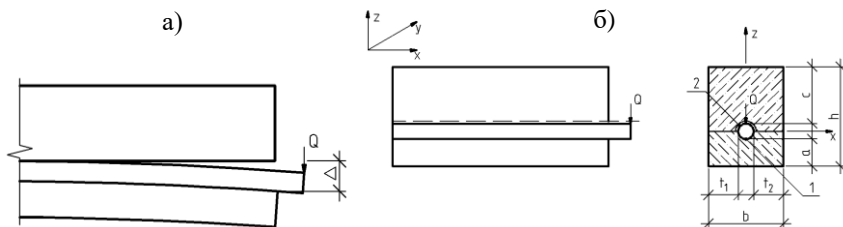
Схема деформации арматурного стержня при действии поперечной нагрузки –а; схема к определению перемещения арматурного стержня от нагрузки, перпендикулярной к оси арматуры –б
